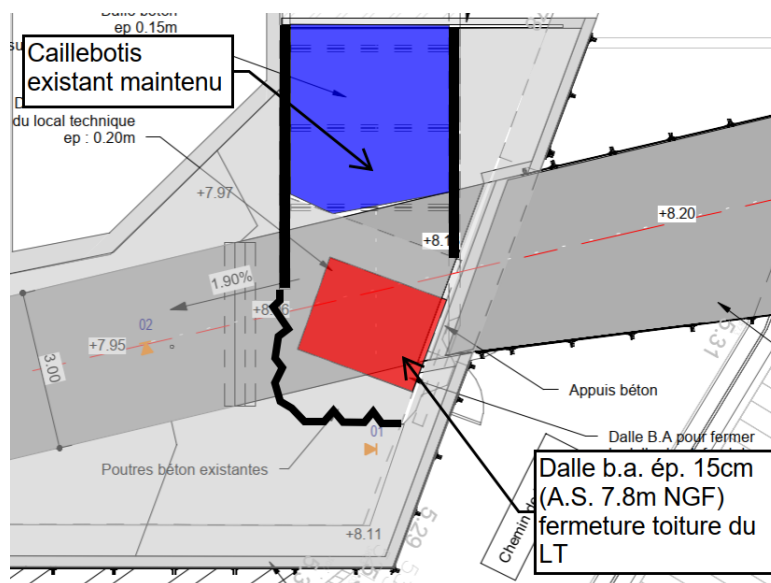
Accès au LT en toiture : trappe condamnée et accès par caillebotis maintenu
